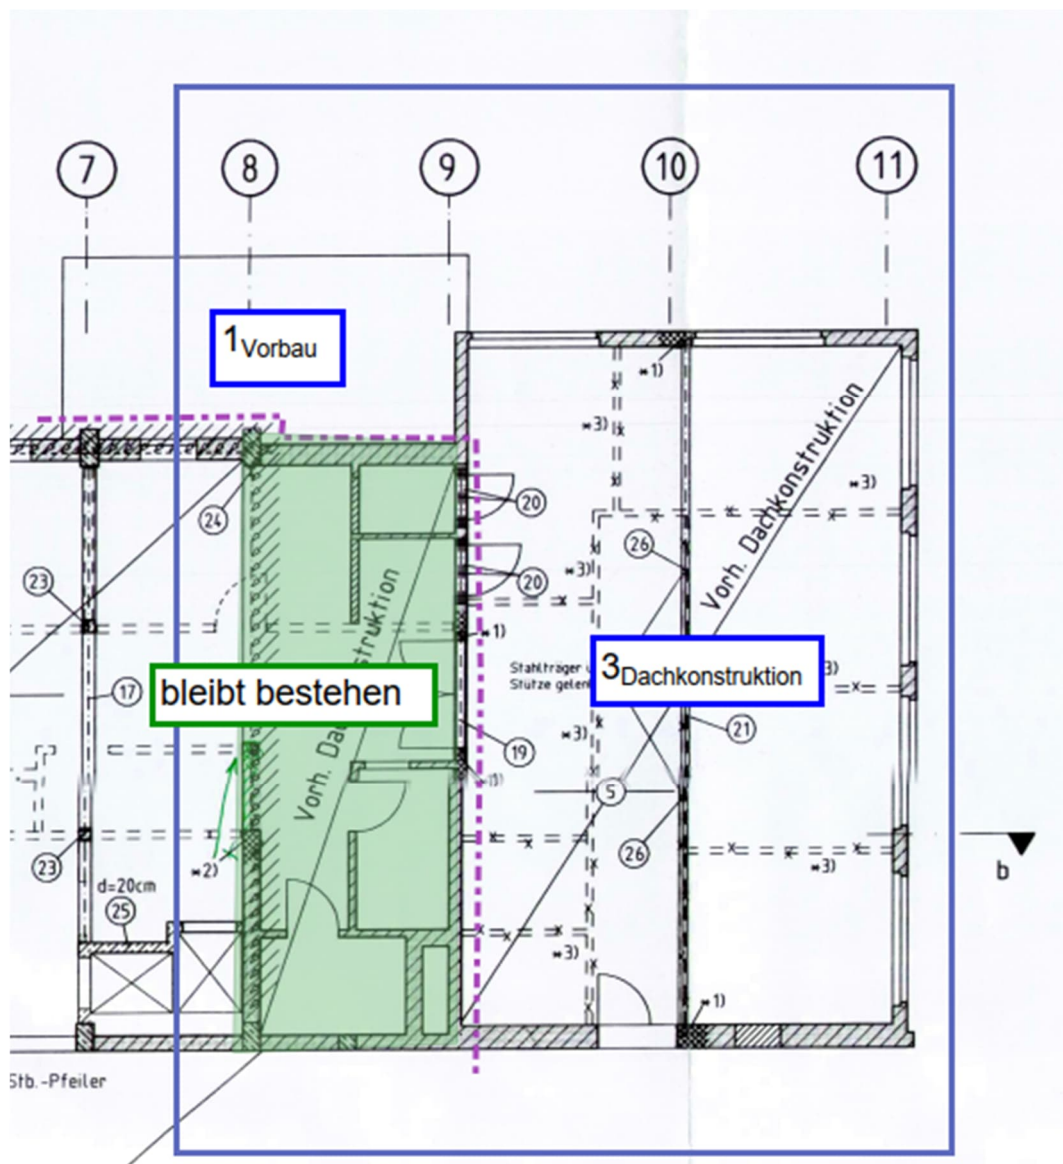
Auszug aus dem Positionsplan P2 Grundriss Erdgeschoss vom 13.05.2005
